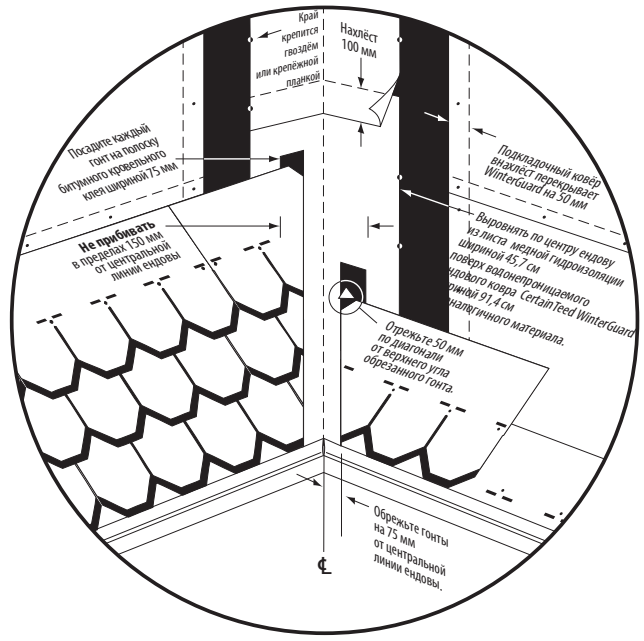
Монтаж ендовы при укладке гонта Carriage House.
